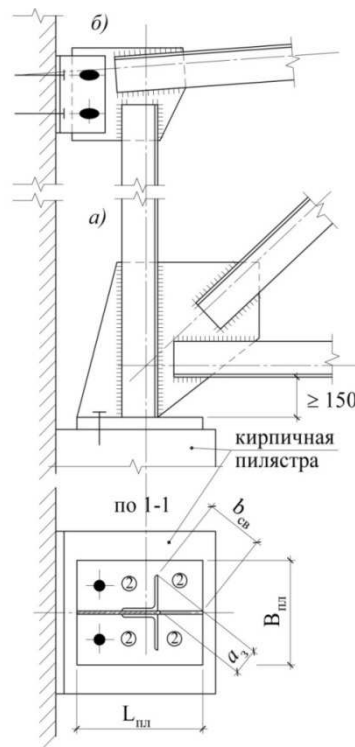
а, б. Нижний и верхний опорные узлы фермы:
